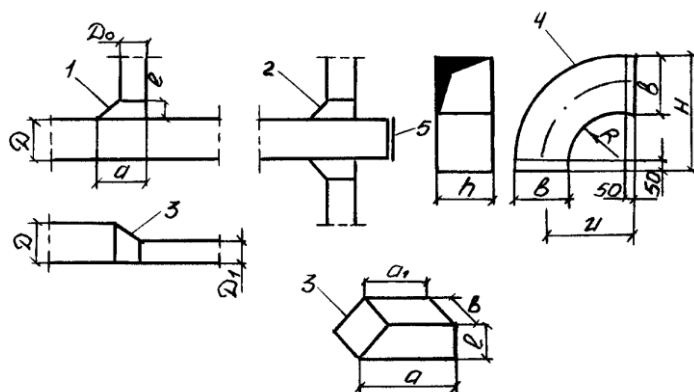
Унифицированные фасонные части воздуховодов: *a* – круглого сечения; *b* – прямоугольного сечения; 1 – прямой тройник; 2 – штанообразный тройник (без заглушки крестовина); 3 – переход; 4 – отводы под углом 90° и 45°; 5 – заглушка; 6 – базовая врезка.
